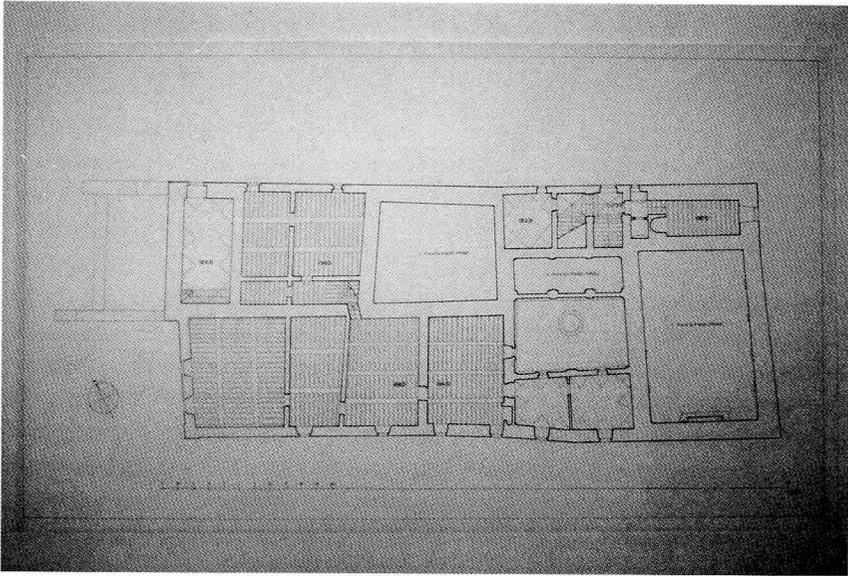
Pianta piano secondo, *ante* ultimi interventi.
